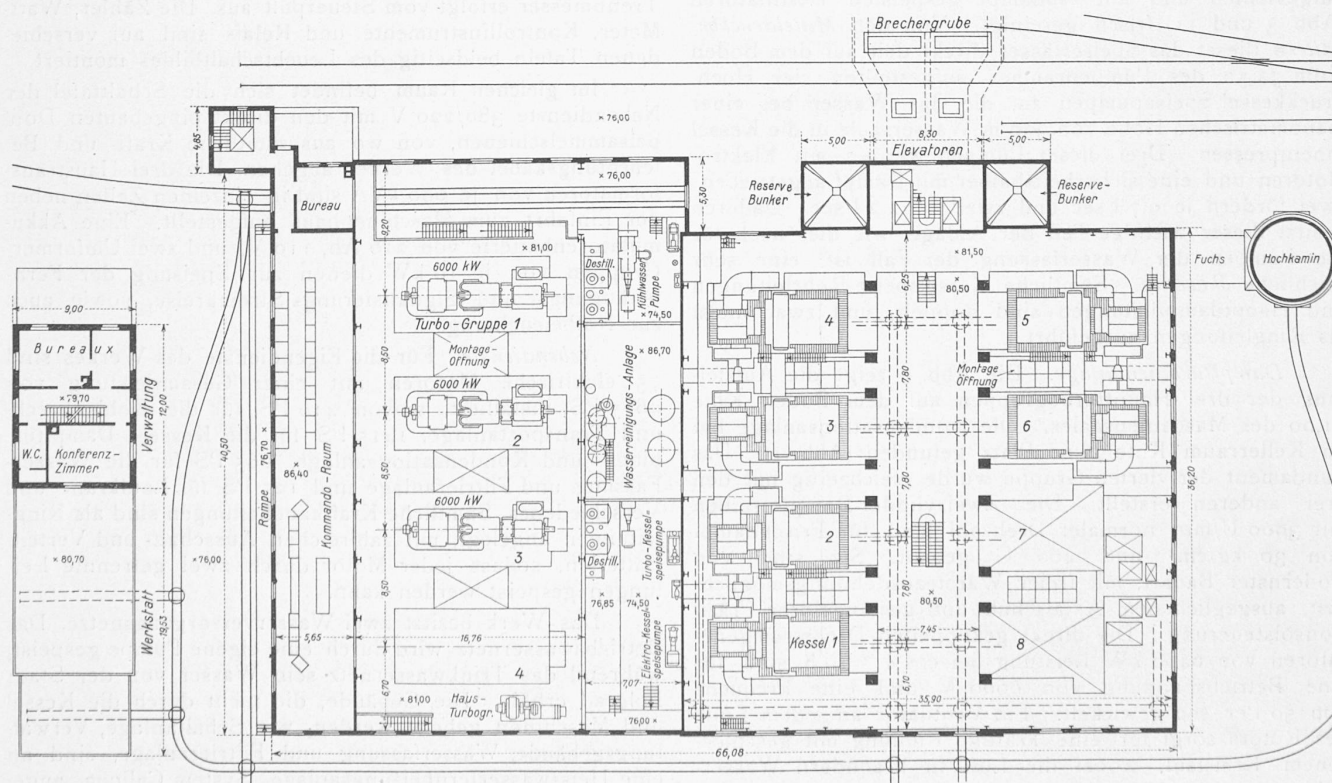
Grundriss der Zentrale über dem Maschinen- und Kesselhausboden (Kote 81,0 bzw. 80,5). Links das Verwaltungs- und Werkstatt-Gebäude. — Masstab 1 : 500.
